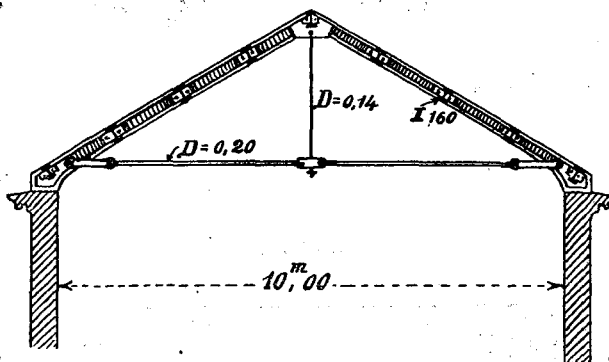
Armadura sencilla con tirante y pendolón.
